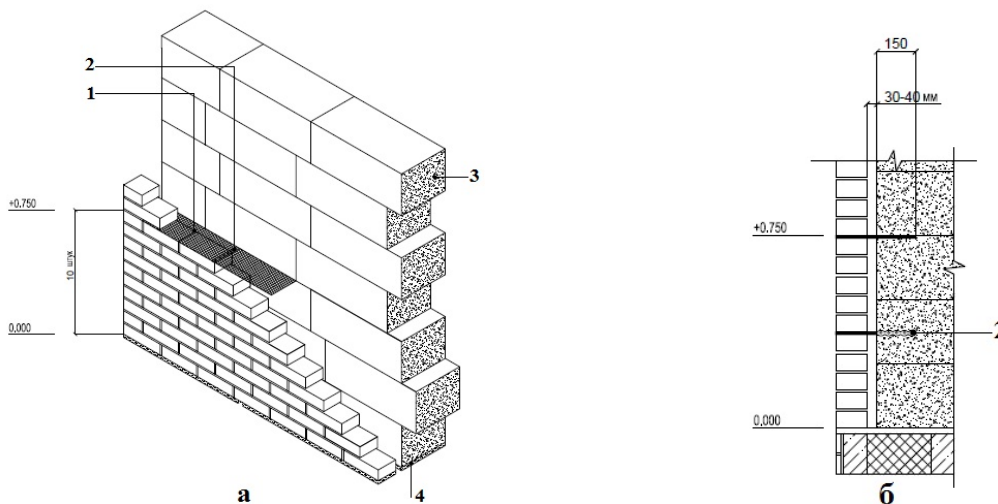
Вариант крепления кирпичной кладки к несущей стене из газобетонных блоков YTONG: а — элемент конструкции; б — разрез по стене; 1 — сетка кладочная Ø 4 мм, огрунтованная; 2 — связи MV 300/5, закладываются в вертикальный шов кладки; 3 — блоки YTONG; 4 — растворный шов
